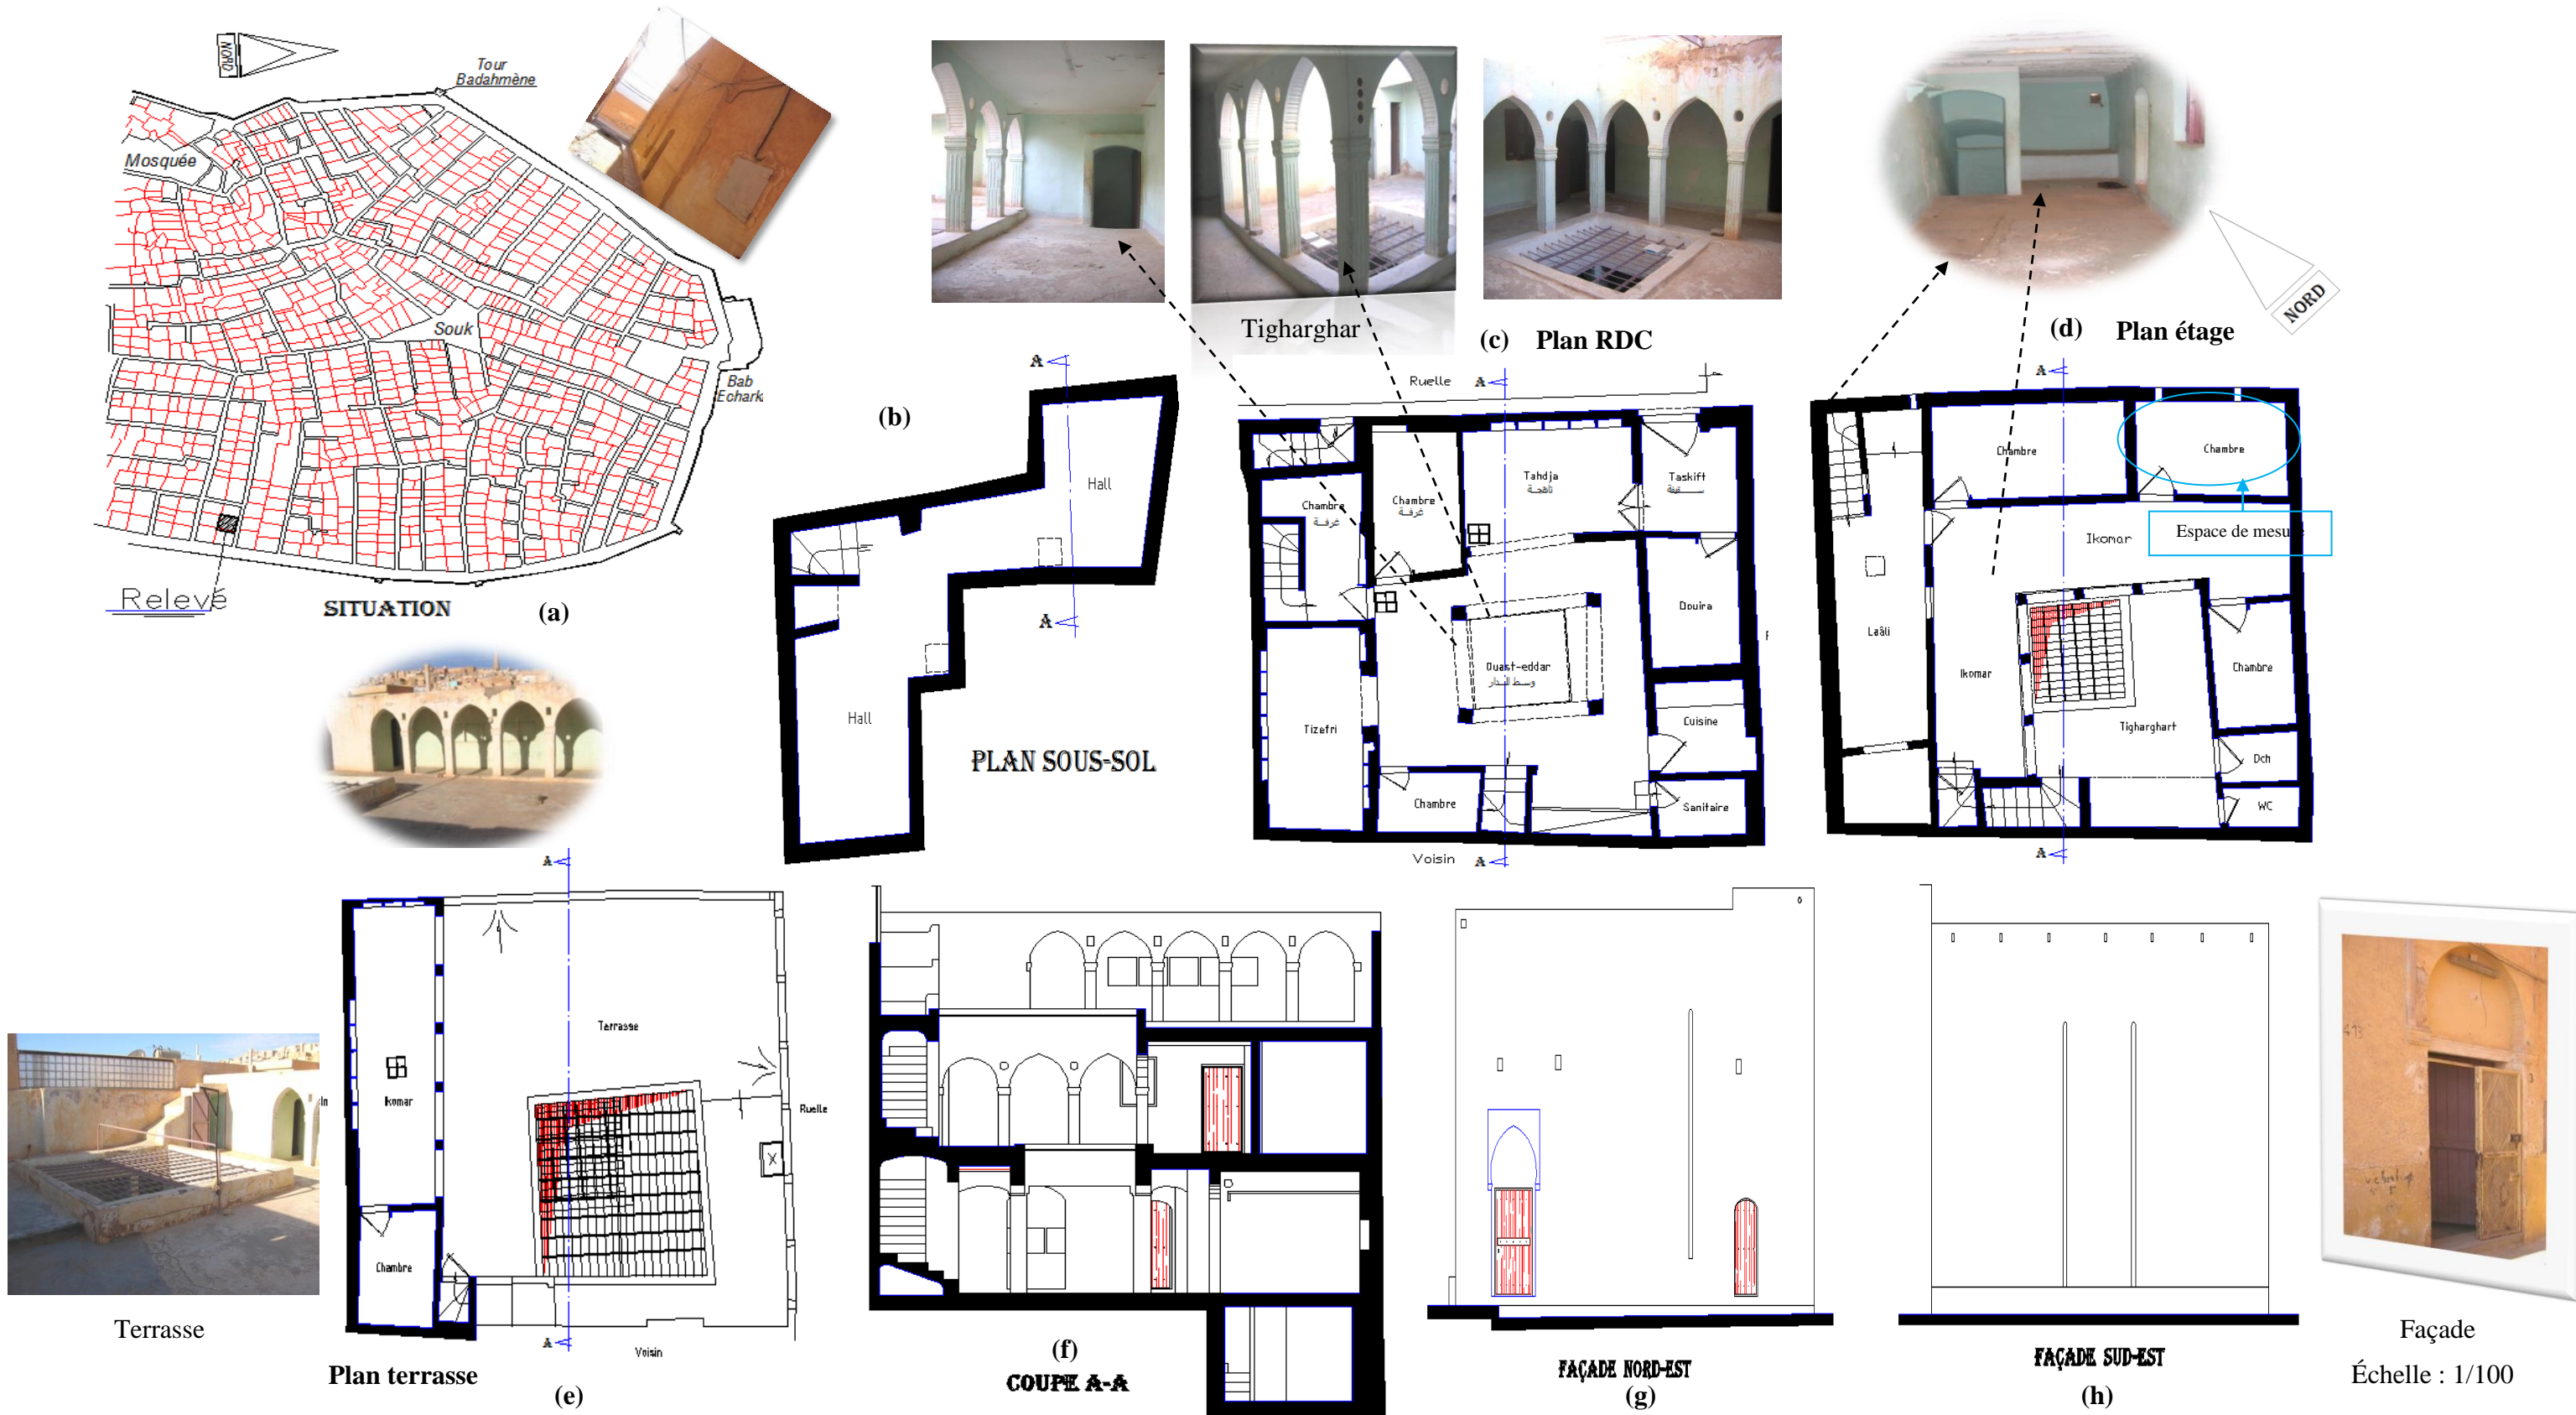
Plan de maison 3 avec photos : (a)Situation (b) Plan sous-sol, (c) Plan RDC, (d) Plan Étage, (e) Plan terrasse, (f) Coupe AA, (g) Façade (OPVM, 2018)
